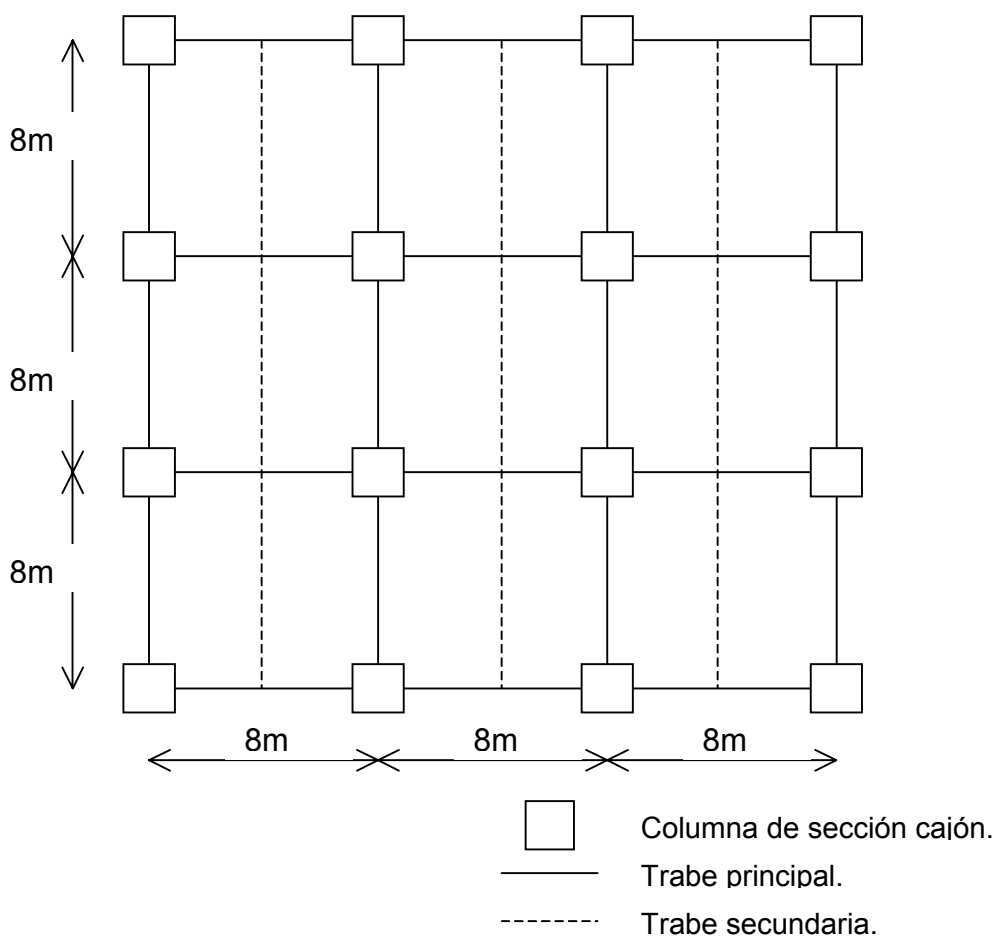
Planta tipo de los edificios de 6 y 12 niveles.
